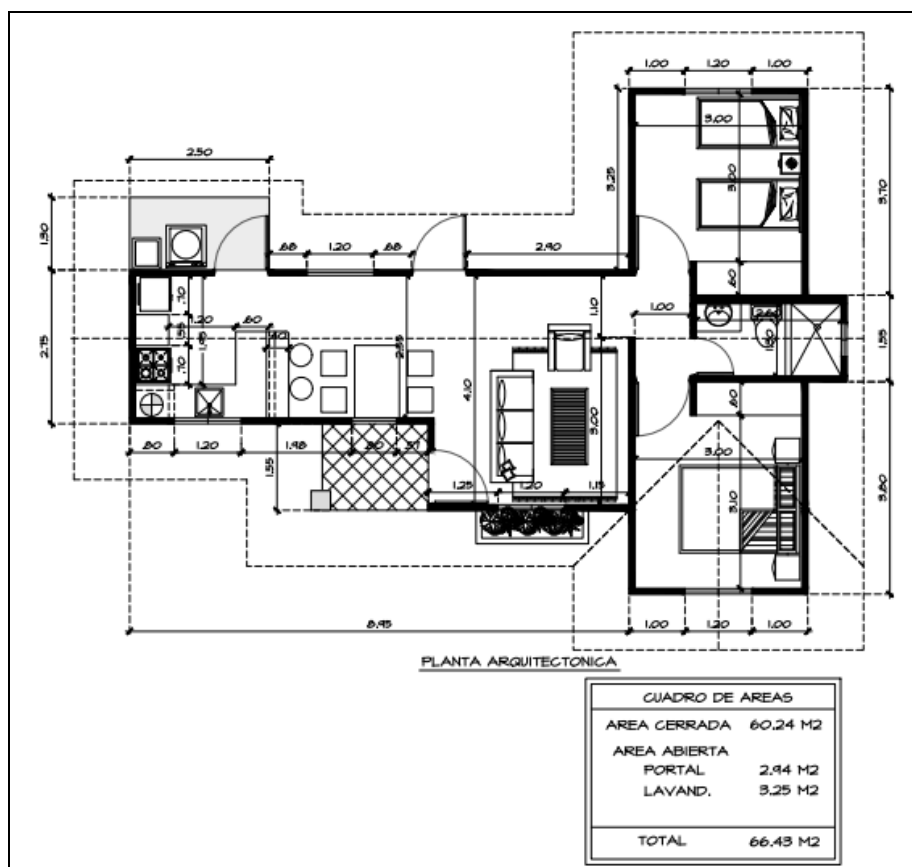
Planta arquitectónica del Residencial Villa Delivi. Fuente: Planos del Anteproyecto
